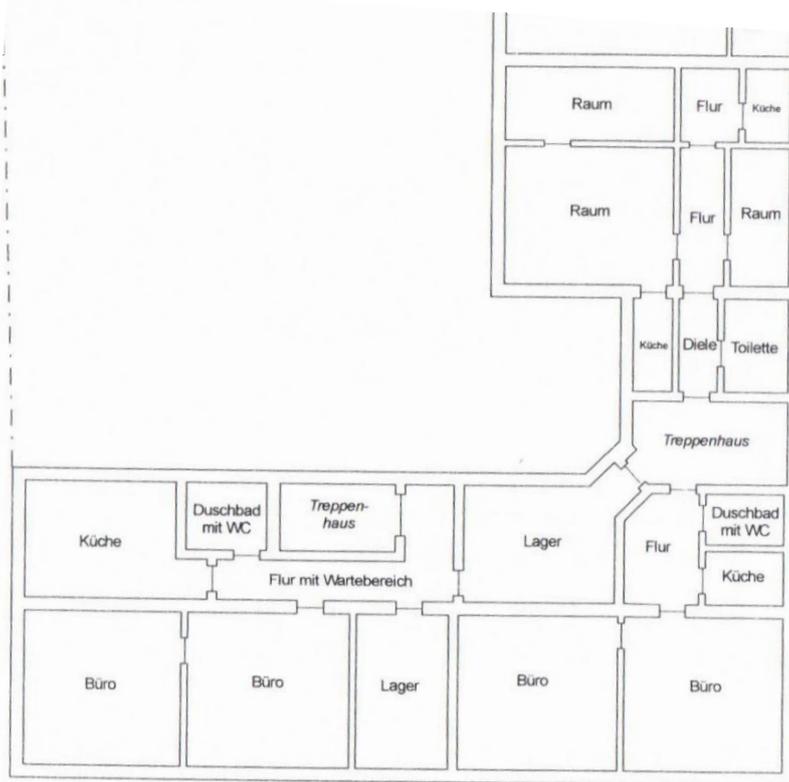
unmaßstablicher Grundriss 1. OG Vorderhaus mit Seitenflügel
